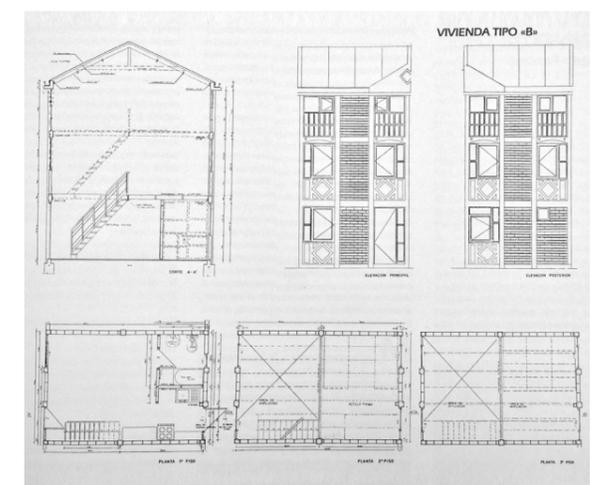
Planimetría vivienda tipo B. Fuente: AECID, Junta de Andalucía, MINVU, 1994.
